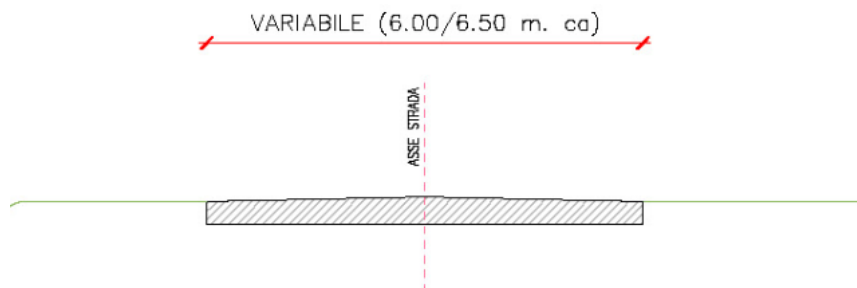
Sezione stradale attuale di Via Stalingrado
